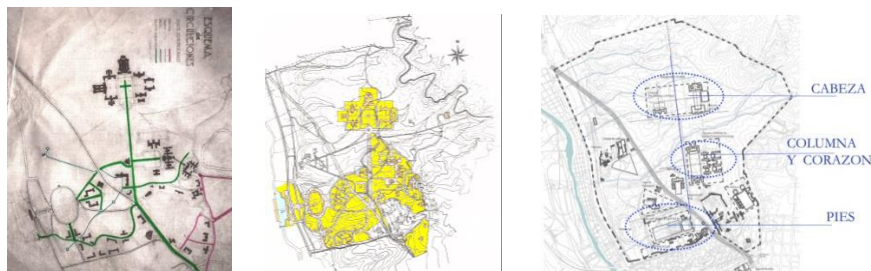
Esquema de Circulaciones, Figura.15. Planta de Proyecto y Zonificación. 1928 Figura 16. Planta de zonificaciones (Cuatro ámbitos de zonificación)
